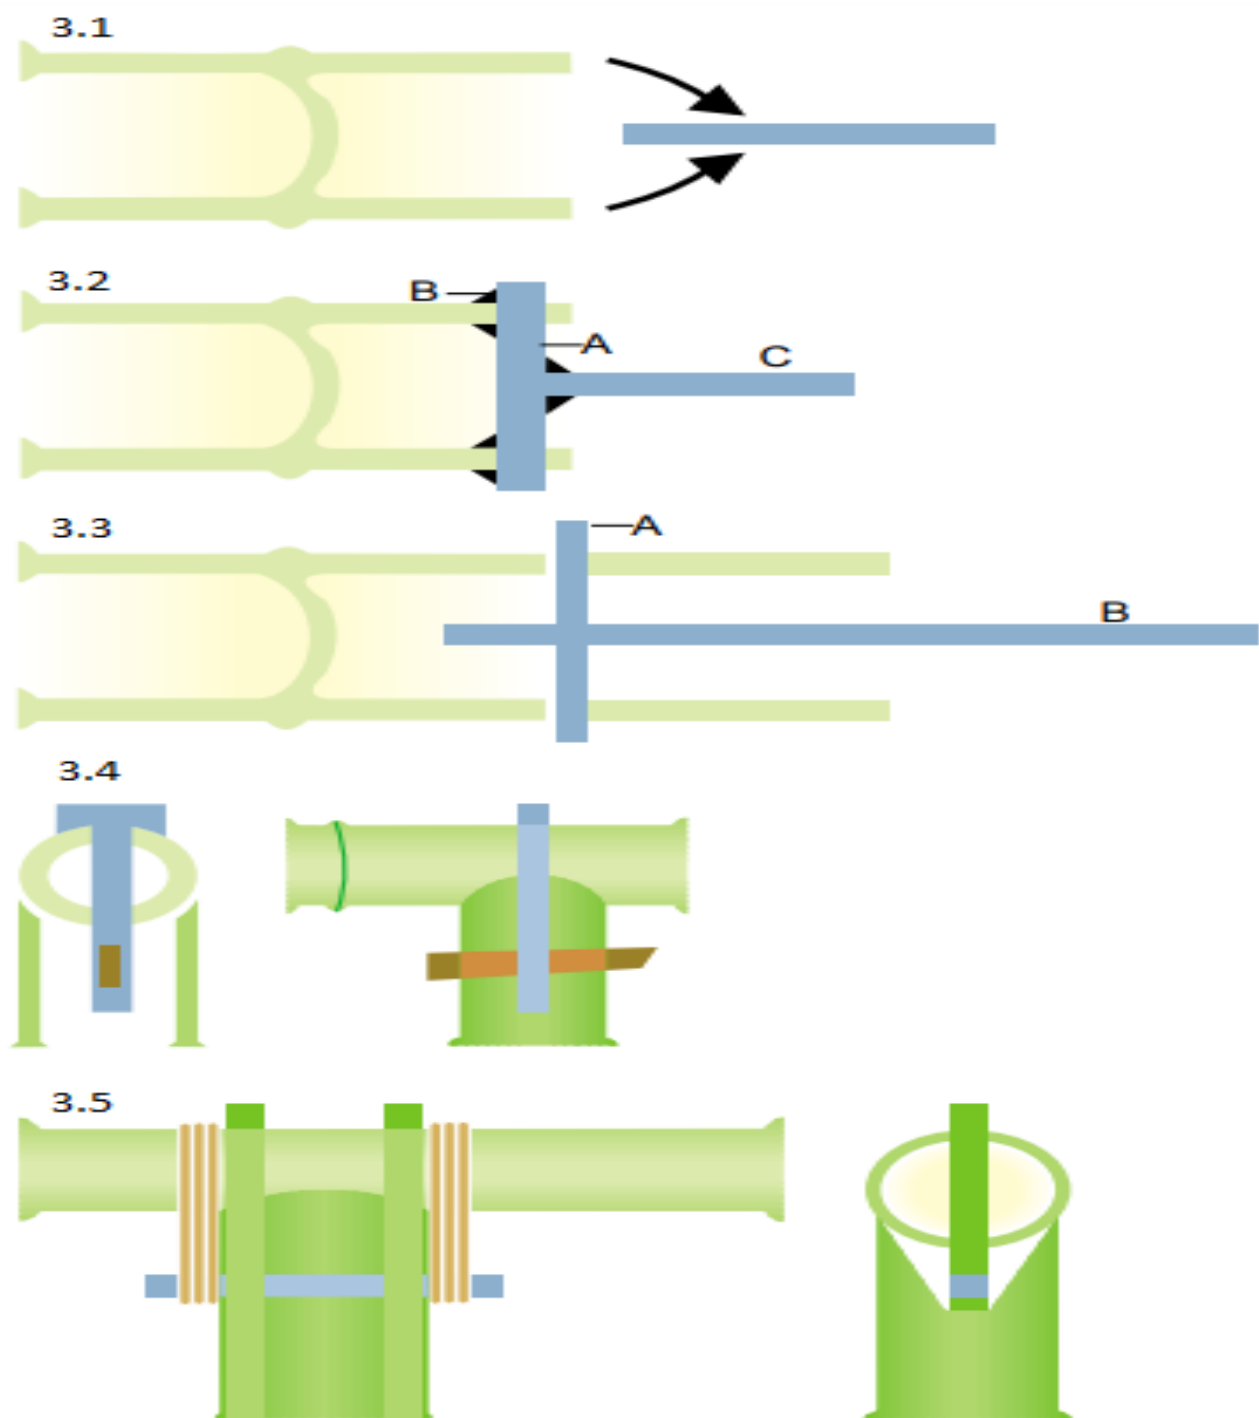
Subtipos de conexiones tipo 3. Fuente: Jansen, 2000
